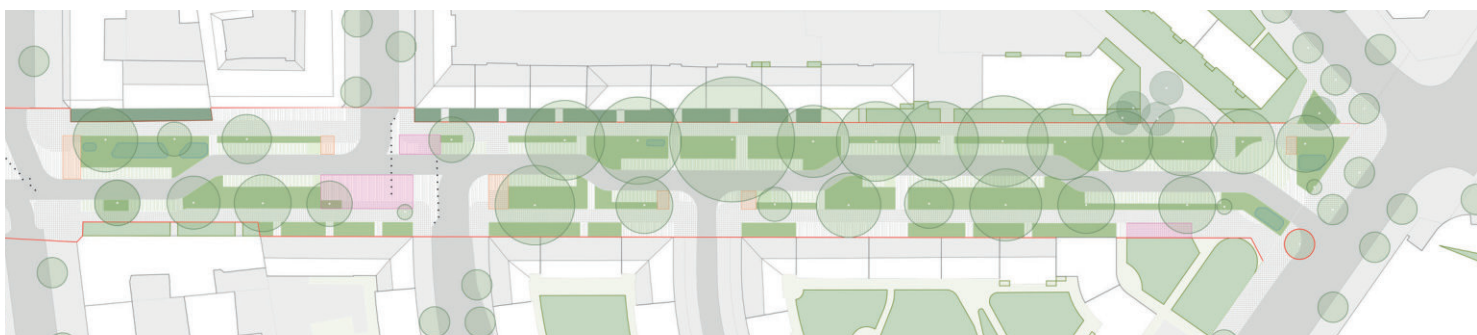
Lageplan Konzept *Mobile Bellermannstraße*, gedreht, Grundlage ALKIS
